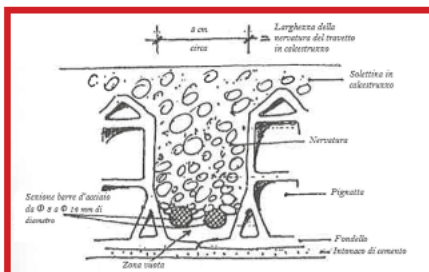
granulometria eccessiva, che può essere accompagnata da dimensioni elevate delle barre e dal restringimento di larghezza del travetto.
